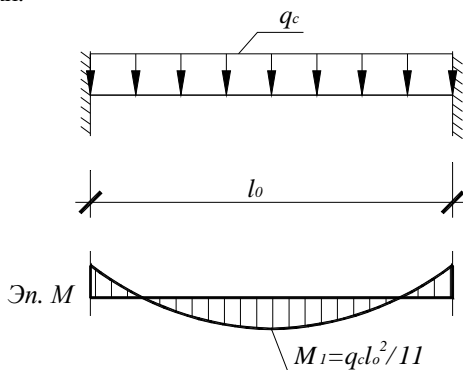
Расчетная схема полки плиты, эпюра моментов.
